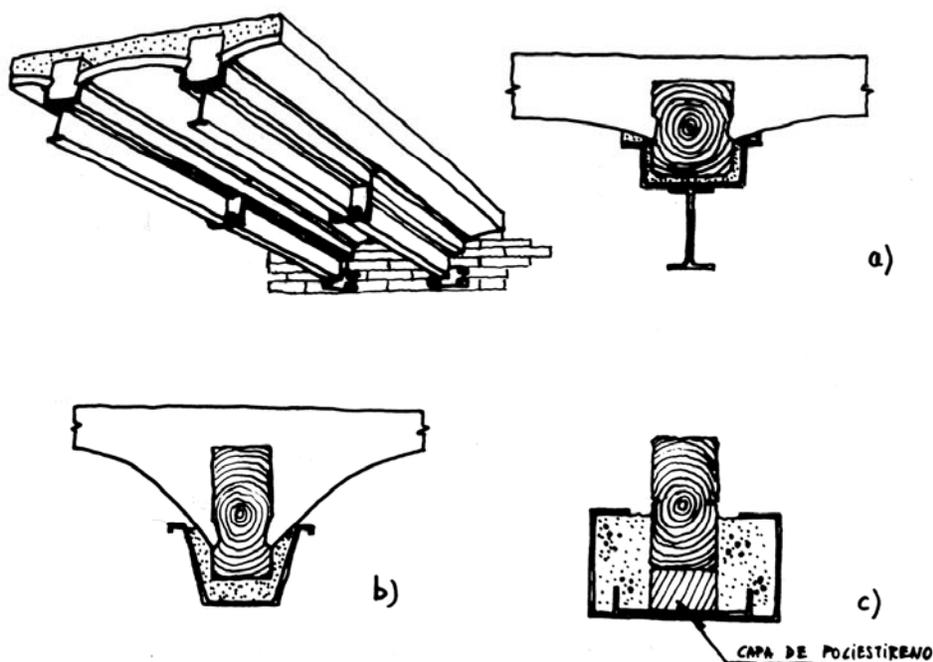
Perfiles metálicos para asumir la función estructural de la vigueta de madera: a) Sistema Herms, b) Sistema Nou Bau y c) Sistema Bettor.
